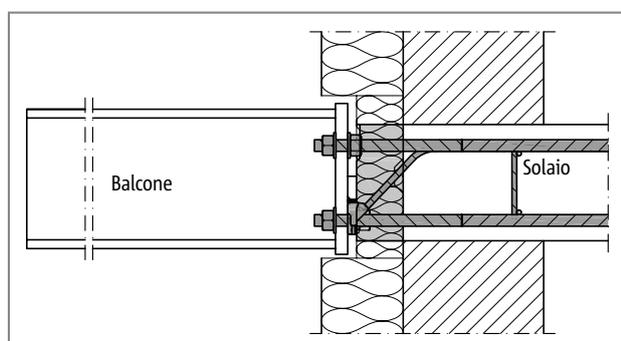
Schöck Isokorb® T tipo SKP: raccordo alla soletta in calcestruzzo armato; materiale isolante nell'isolamento esterno
